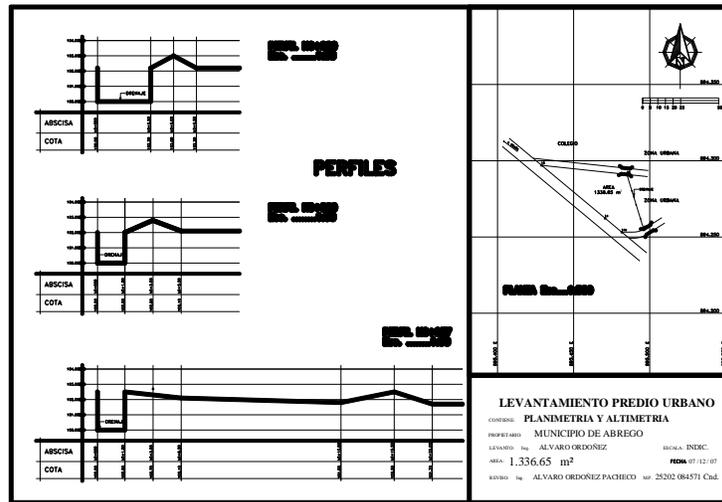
Levantamiento planimétrico y altimétrico del lote para el proyecto.
